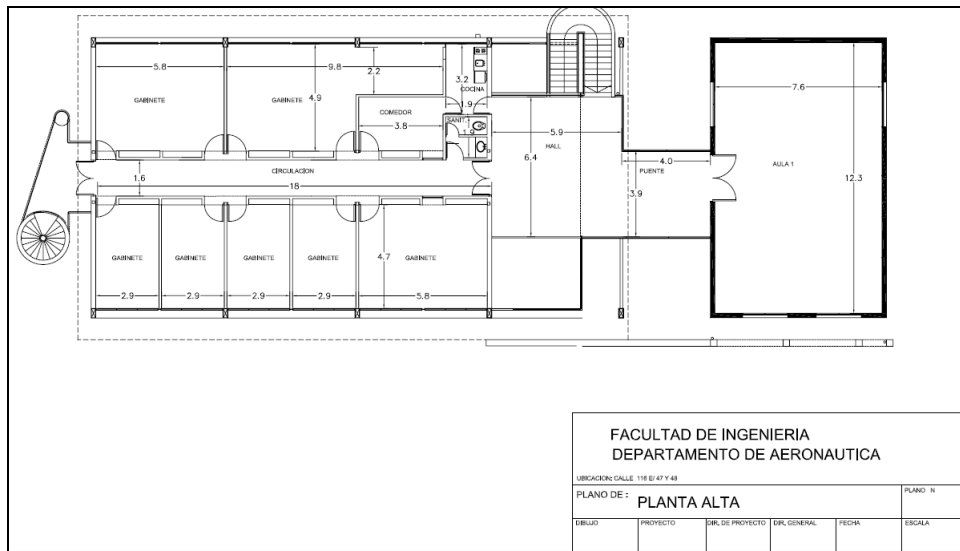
Plano de la planta alta del Edificio Principal
